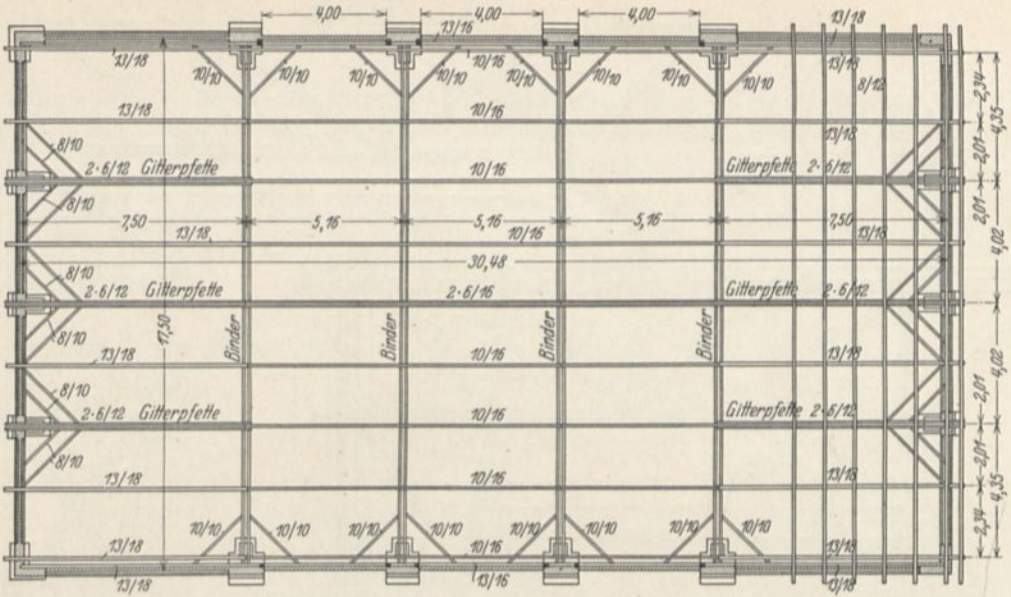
Scheune auf der Domäne Woidtke i. P. Grundriß mit Pfetten und Sparrenlage.
